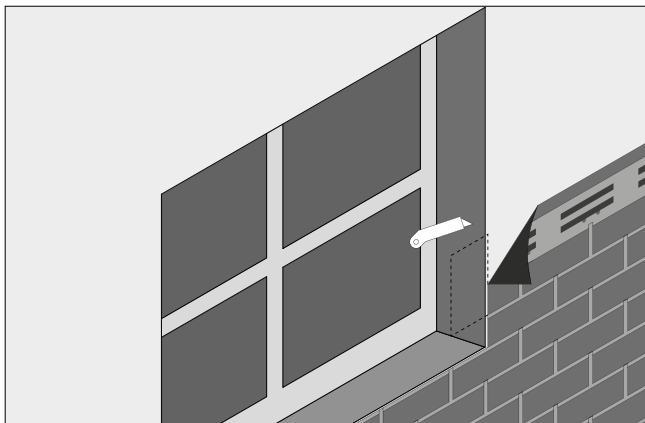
Монтаж фасадной плитки вокруг оконных проемов
